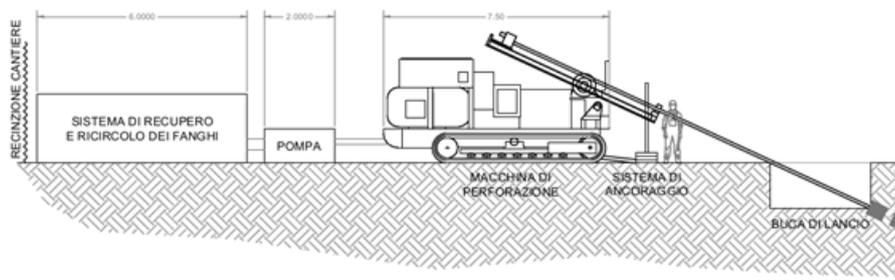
Layout di cantiere sulla terraferma per l'esecuzione di una TOC – sezione tipo
